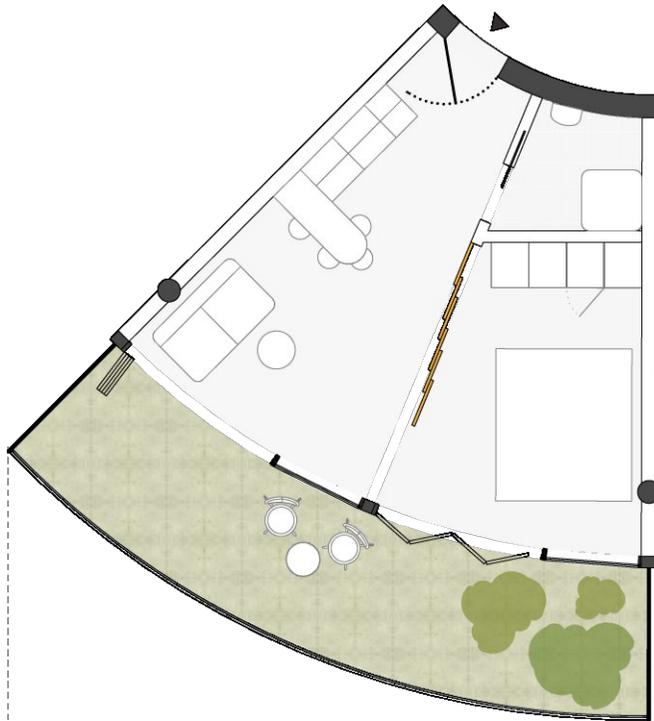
Grundriss Wohnung Typ A.a, halboffen
